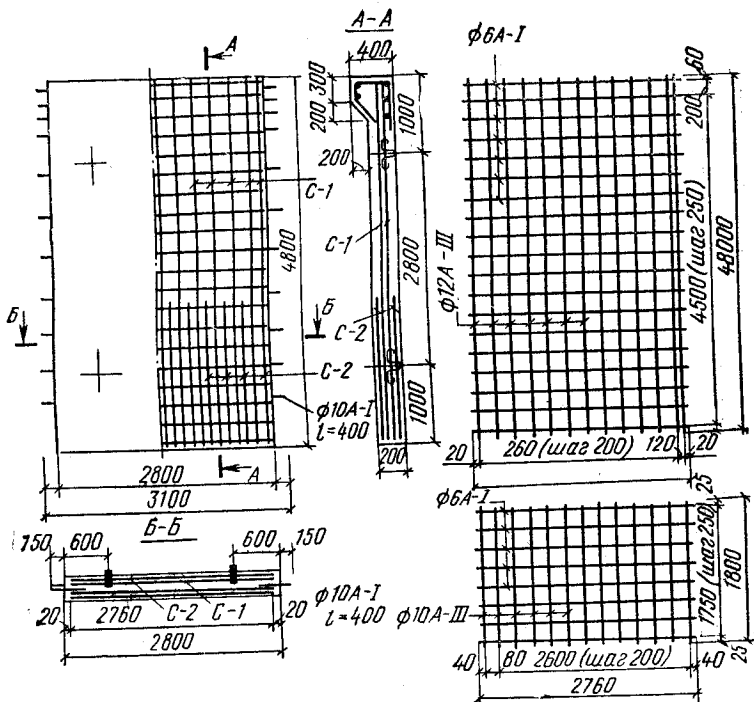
Армирование стеновой панели прямоугольного резервуара
